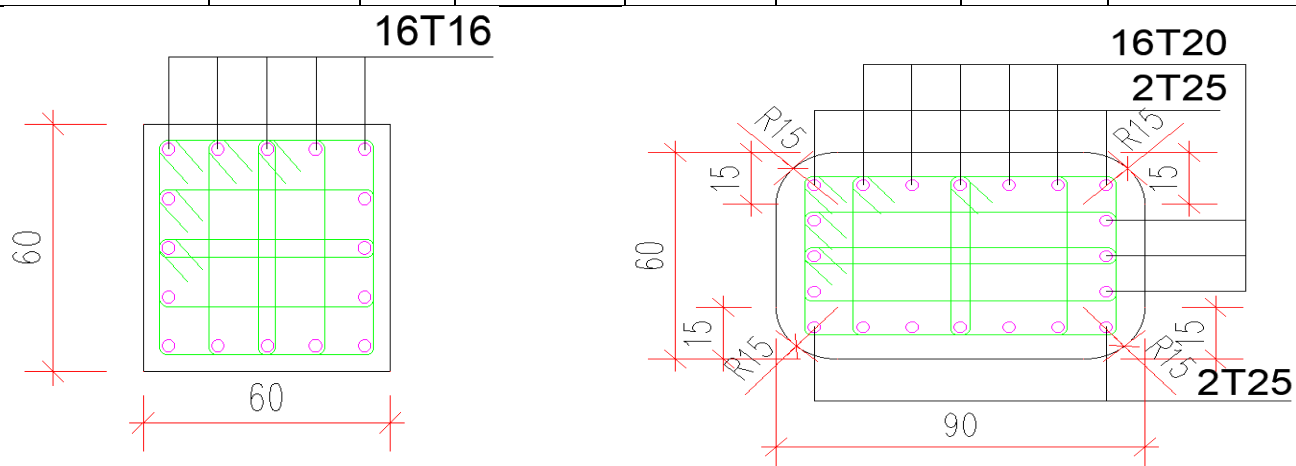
ferrailage des poteaux de bloc de prière.
